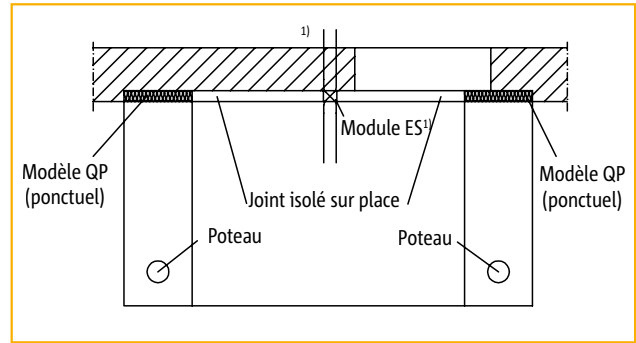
balcon appuyé sur des poteaux et ponctuellement sur la façade
